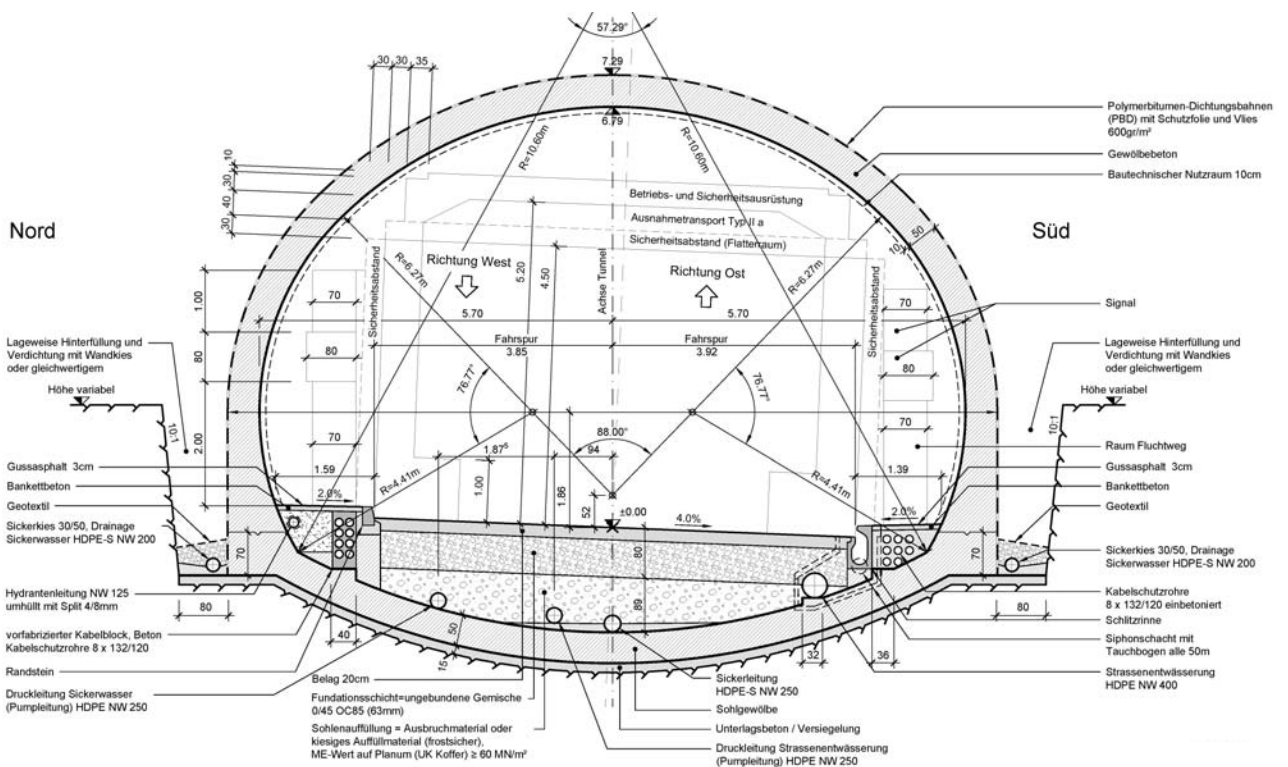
Skizze Normalprofil Tagbautunnel (siehe auch Plan TU.101)
